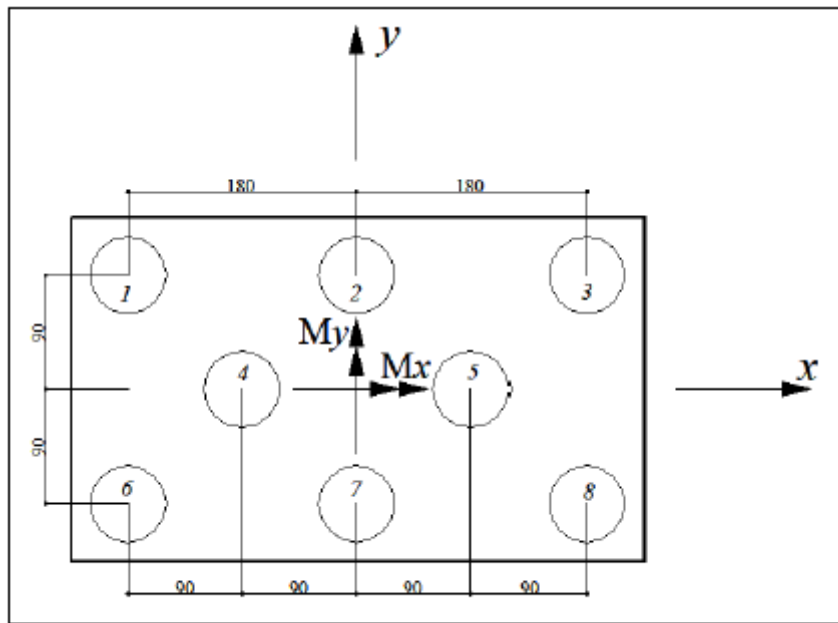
Planta baixa de um bloco sobre estacas (medidas em cm)
